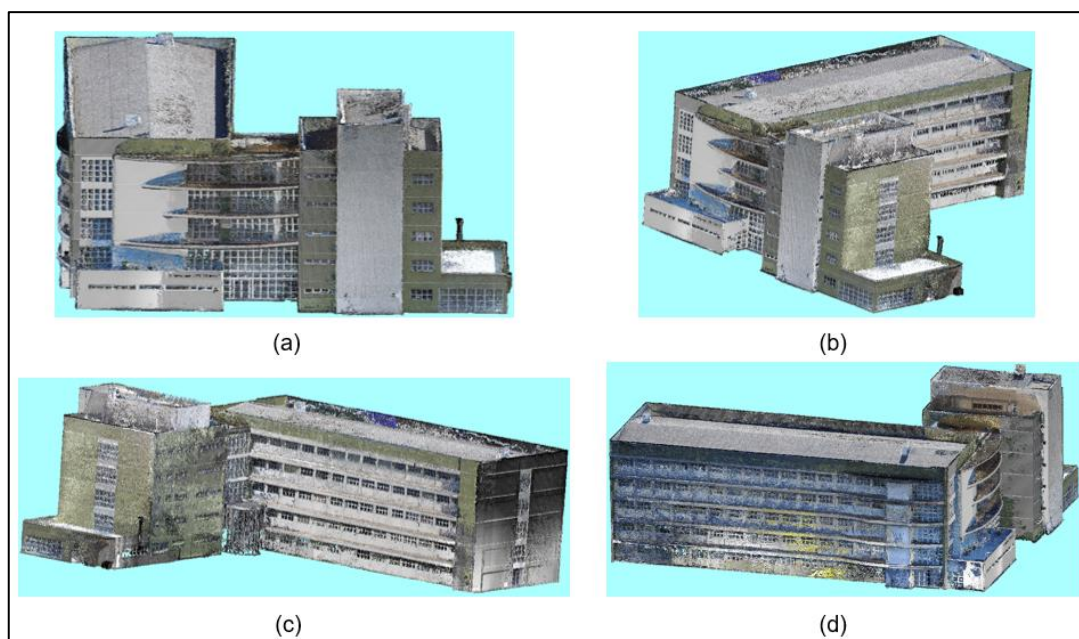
Edifício da Clínica Escola da Terapia Ocupacional modelado por Fotogrametria de telhado e de fachada.
